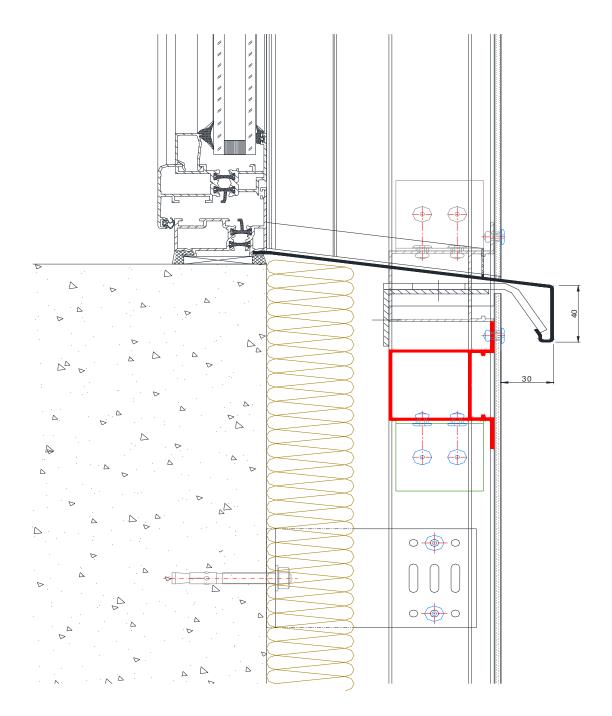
Appuie de baie – Coupe verticale – Système riveté RV 60 4c
